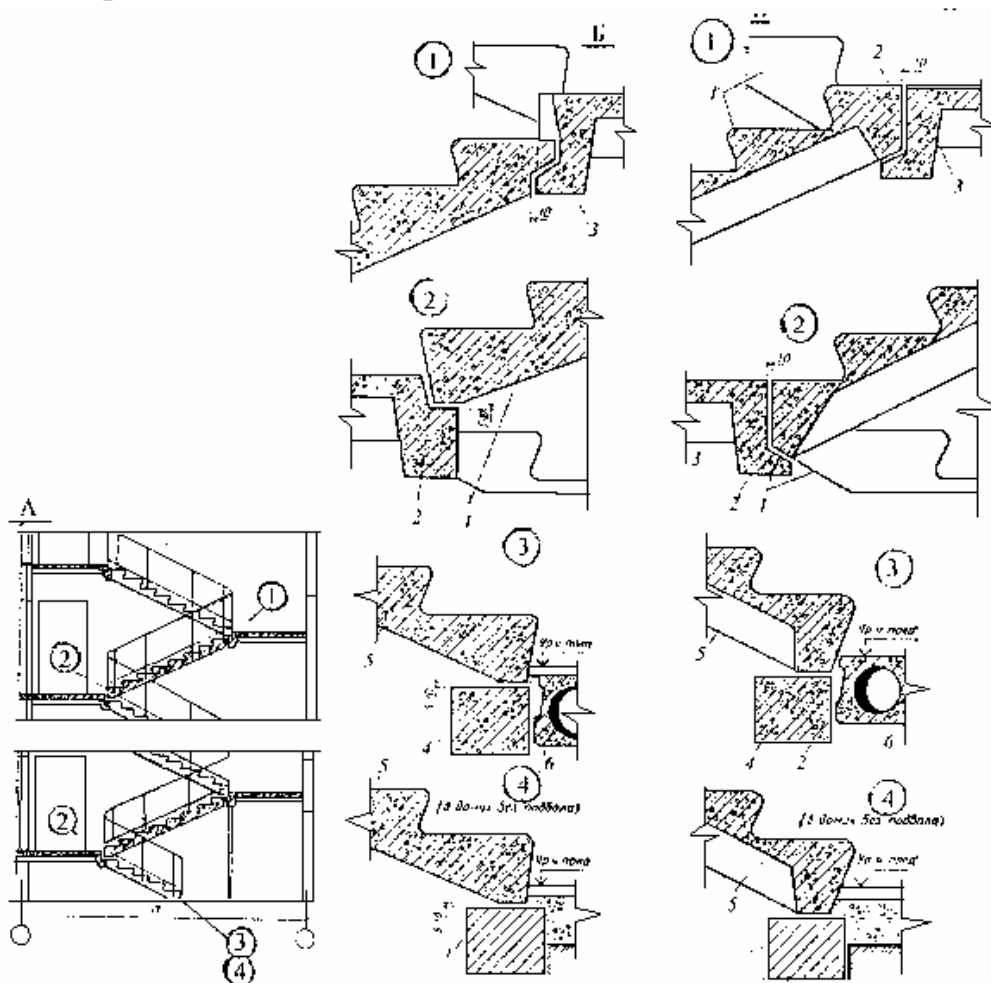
Конструкции лестницы из сборных железобетонных элементов:
